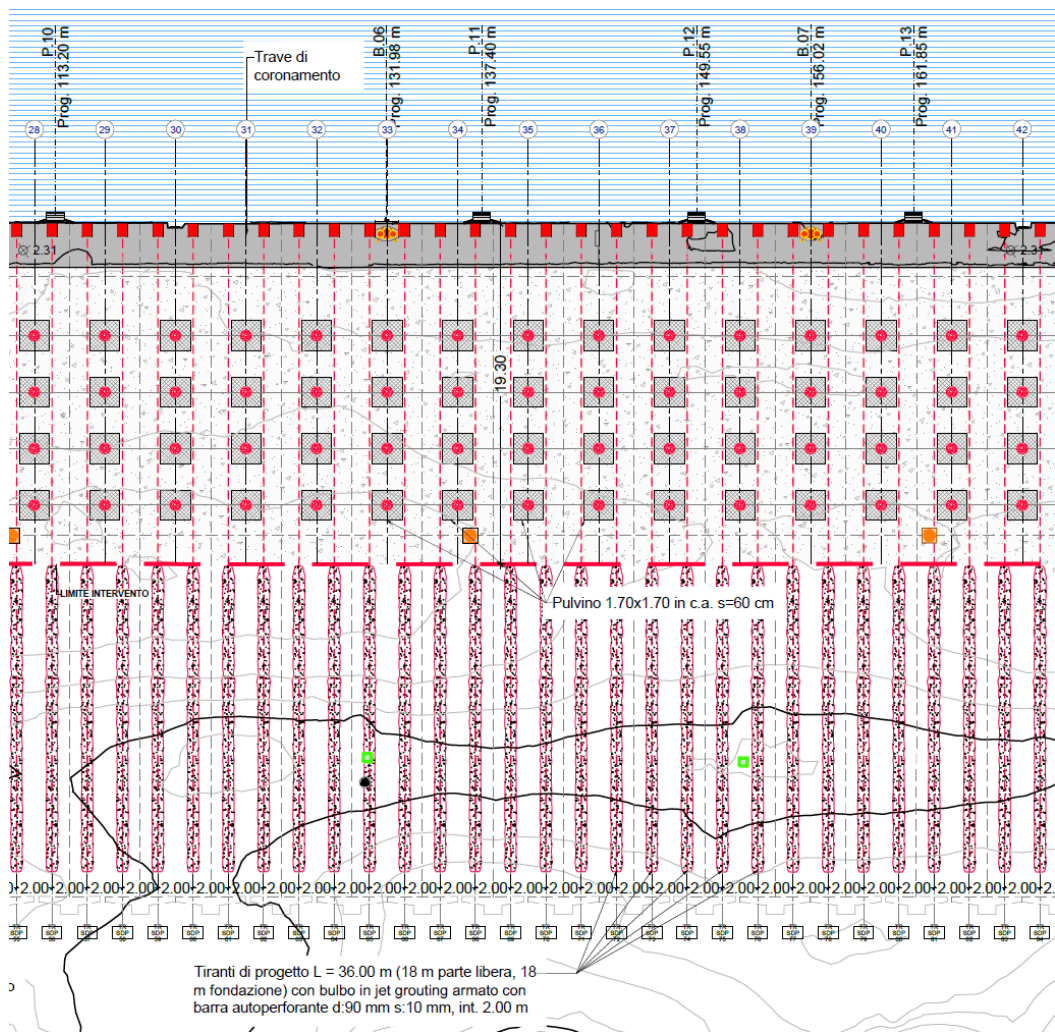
Stralcio opere strutturali da progetto esecutivo
